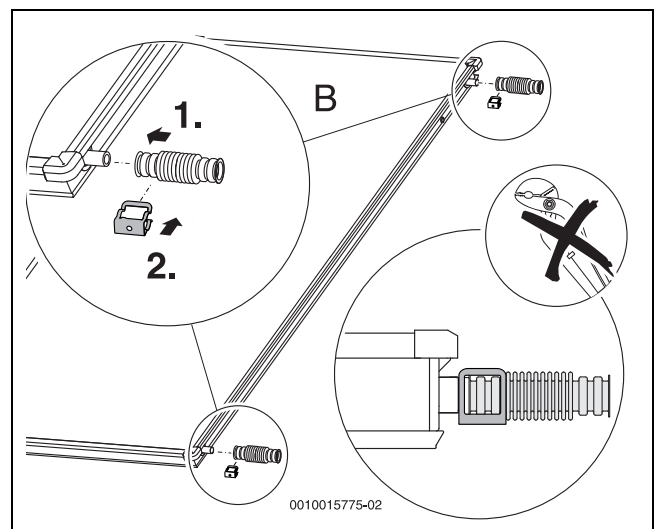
Montar el set de conexión hidráulica en el colector izquierdo
